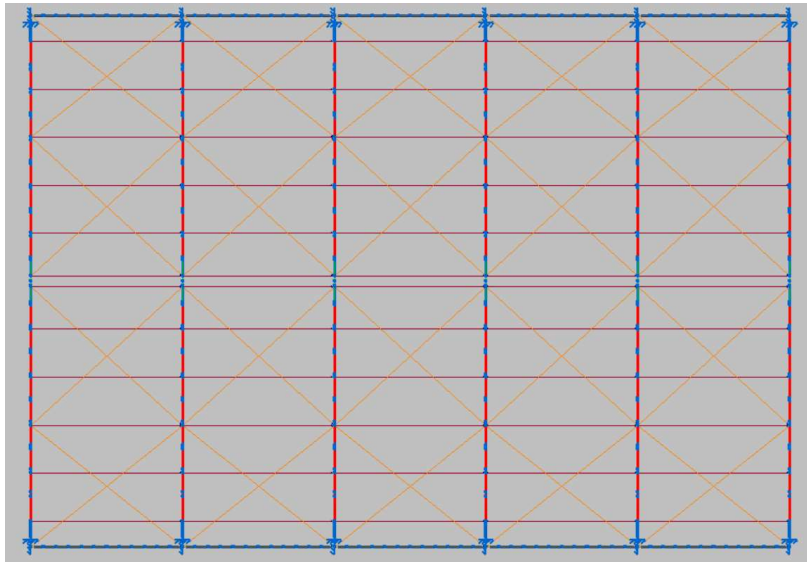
Vista en planta de la cubierta de la nave industrial
